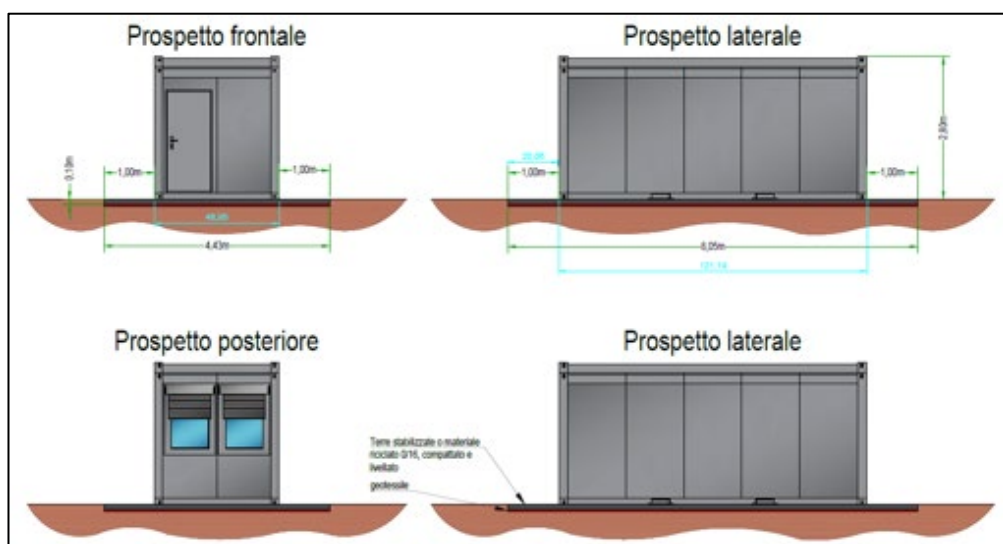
Container magazzino, control room – Pianta e Prospetto (GAV20\_021800\_IMP\_D\_Architettura\_Locali\_e\_Cabine\_elettriche)
